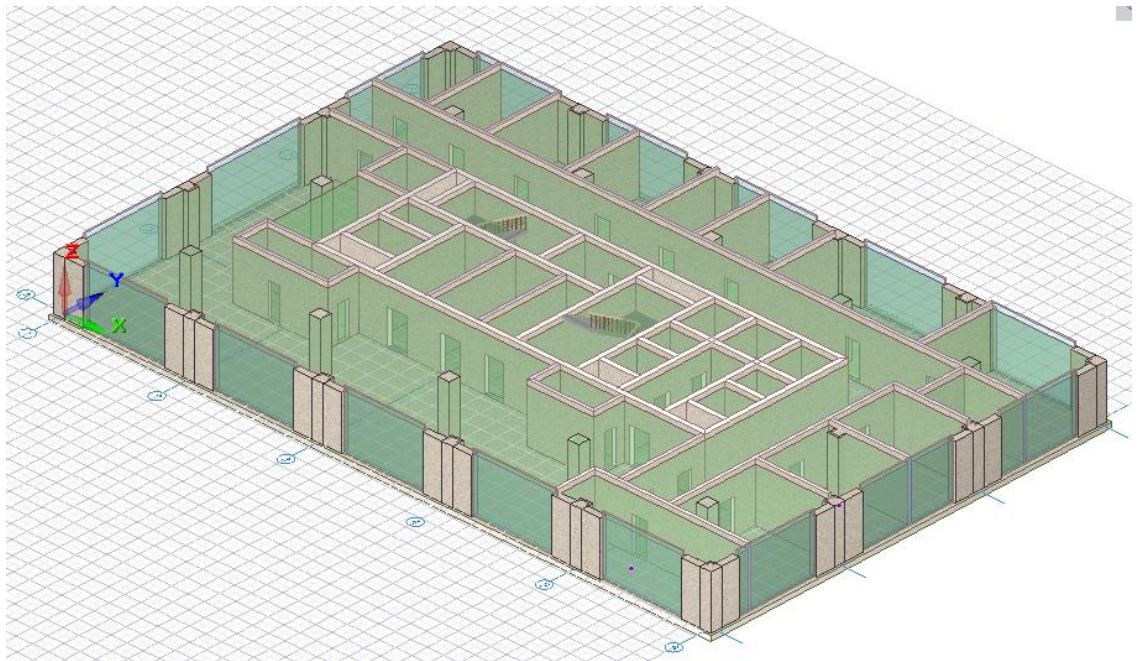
Расположение помещений типового этажа высотного здания
